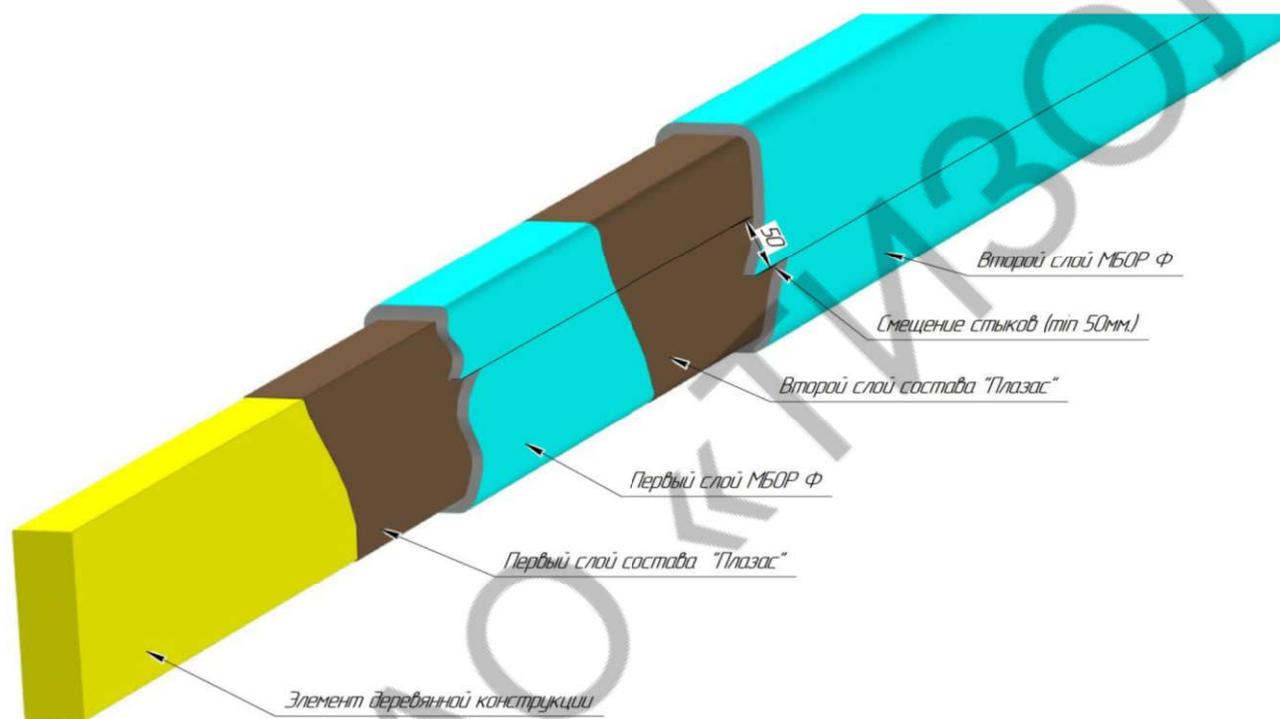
Монтаж системы «ЕТ ДРЕВО» на совмещенные конструкции.
